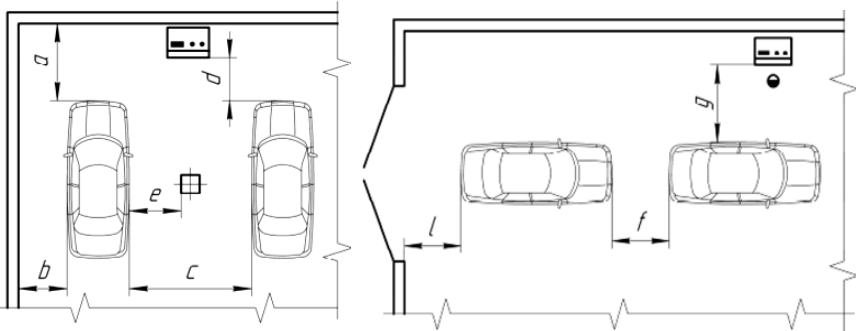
Нормативные расстояния между подвижным составом и элементами строительных конструкций зданий в производственных помещениях
